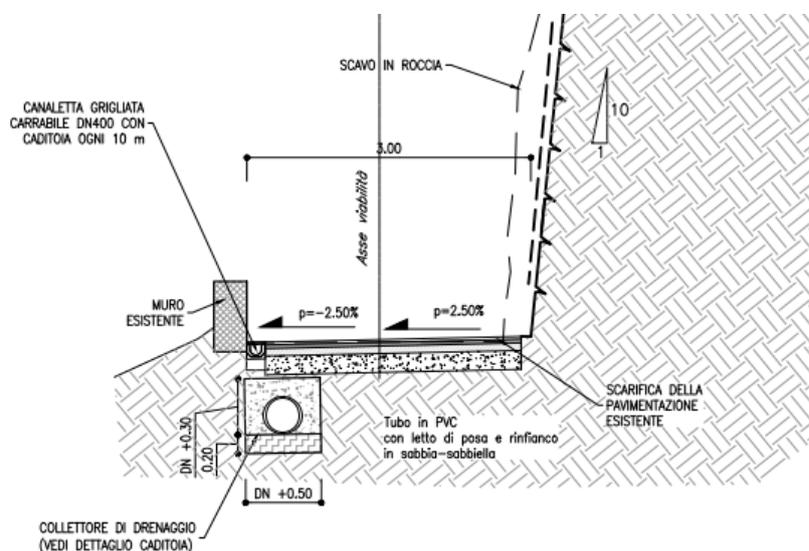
Sezione stradale tipo larga 3,0m con canaletta
